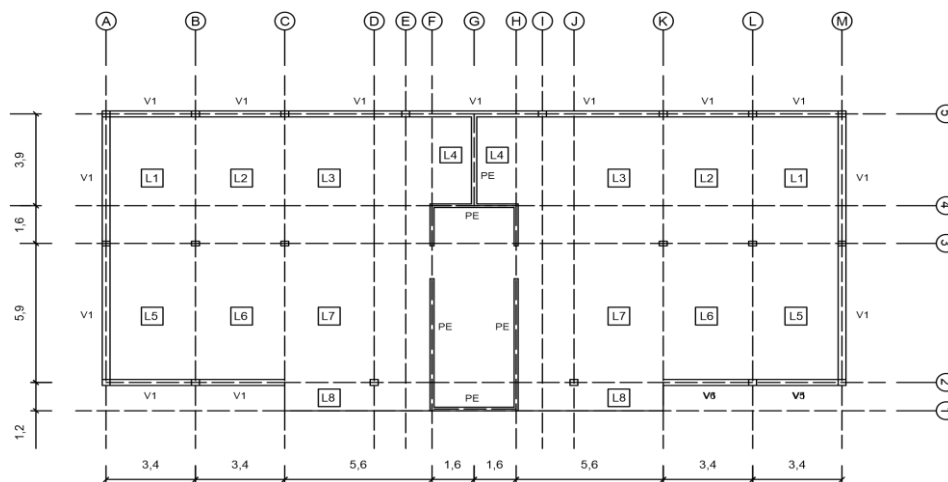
Planta de dimensionamento do caso de estudo 2
